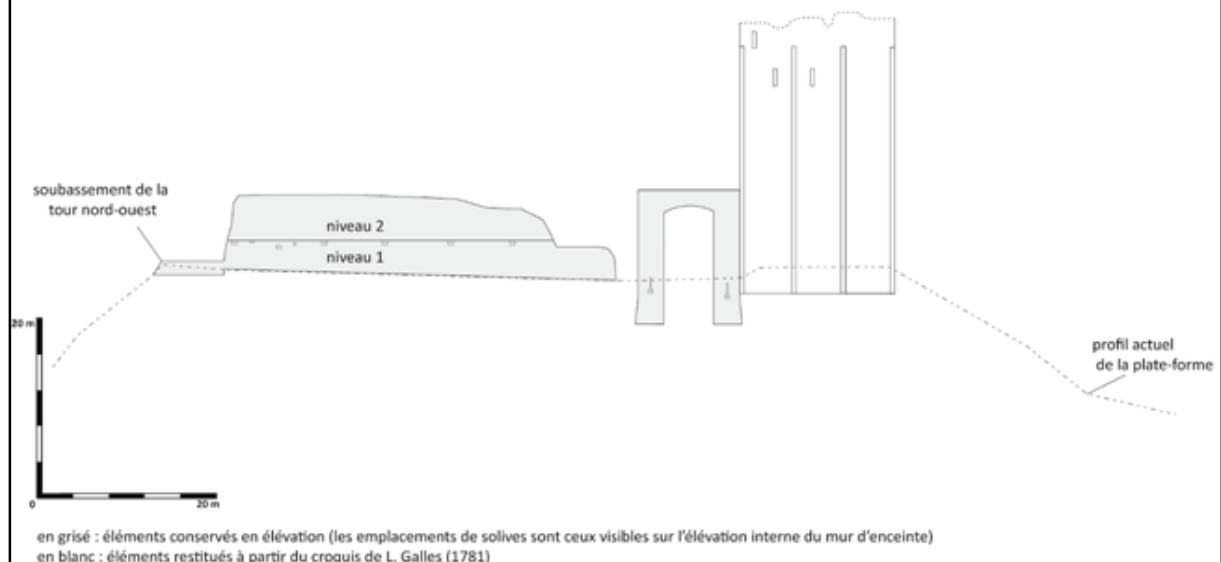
Essai de restitution de la façade ouest du château de Rieux d'après le dessin de Louis Galles (1781)<sup>143</sup>.
